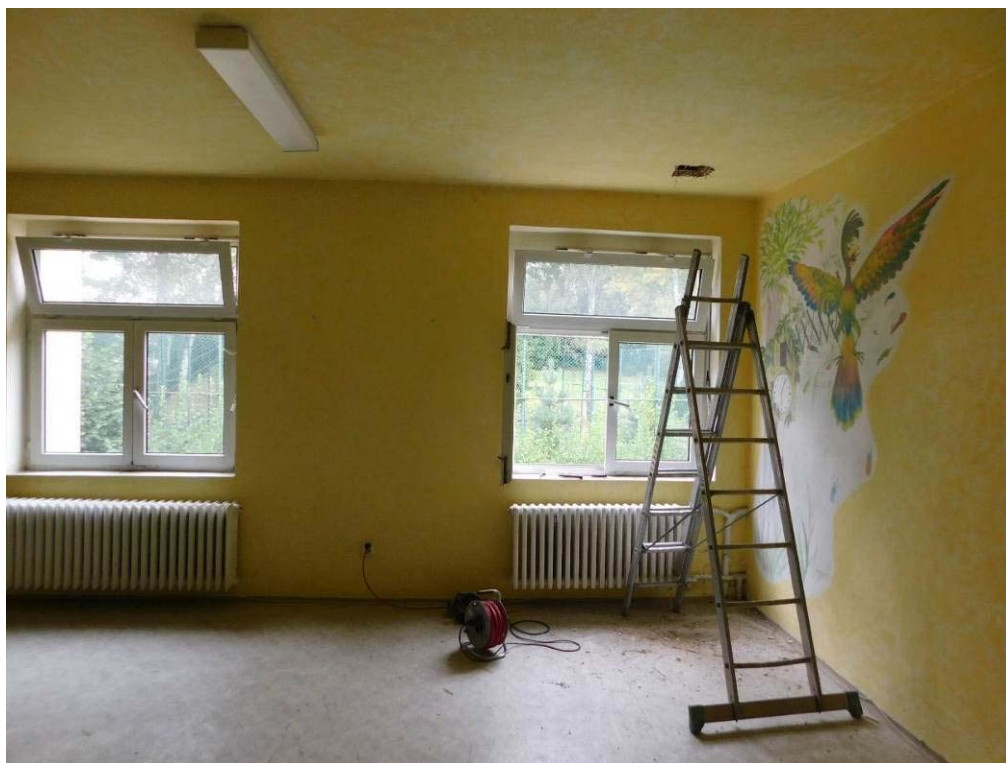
Sonda K9 – Sonda do podhledu 2.NP (na severní straně středové části objektu, střešní krytiny IPA) – zjištěn železobetonový trámový strop s dřevěným podhledem (omítka na rákos)
